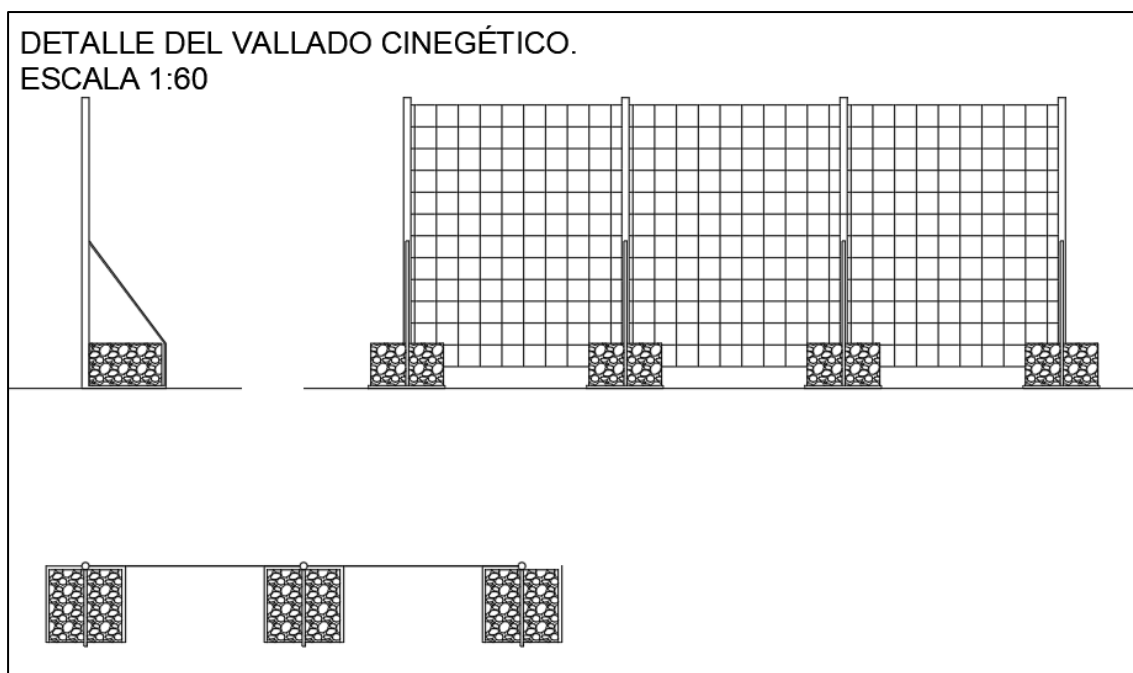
Detalle del vallado cinégetico a instalar perimetralmente en los bloques fotovoltaicos
